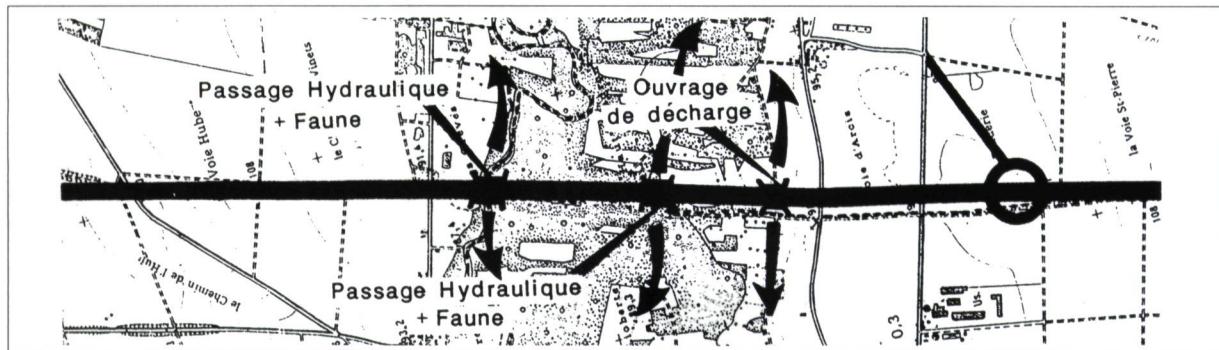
PASSAGES MIXTES HYDRAULIQUES - FAUNE EN VALLEE INONDABLE
